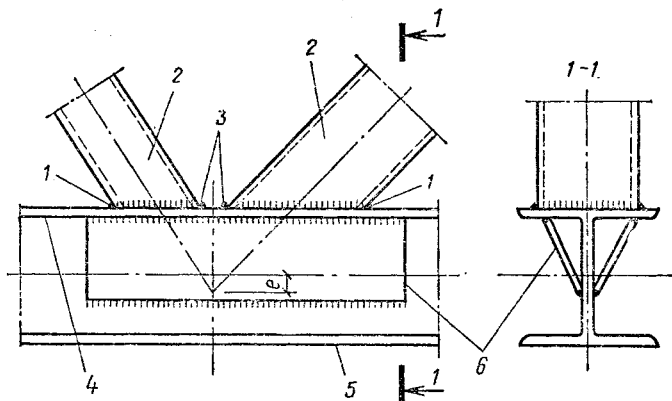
Обозначения элементов в узлах фермы с поясами из широкополочных двутавров (ШПД) и решеткой из гнутосварных замкнутых профилей (ГСП)
